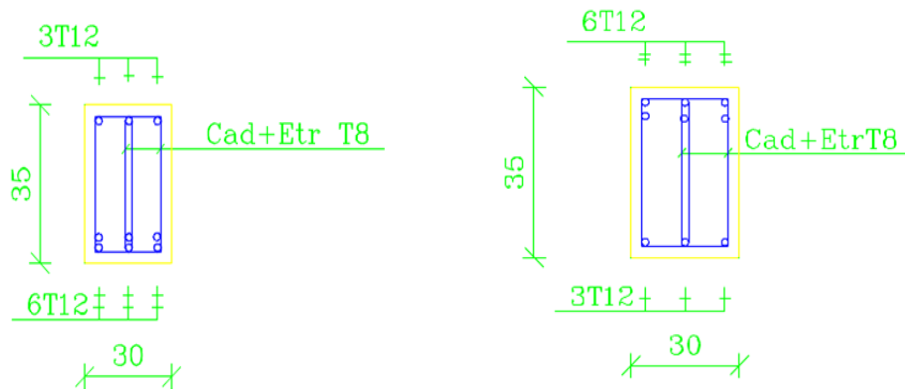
Schéma de ferraillage des poutres secondaire.
